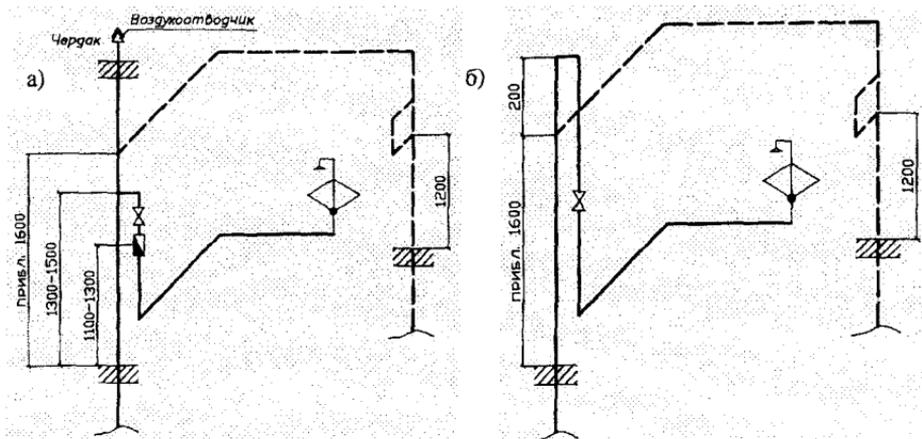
Схемы присоединения циркуляционного трубопровода к подающему:
